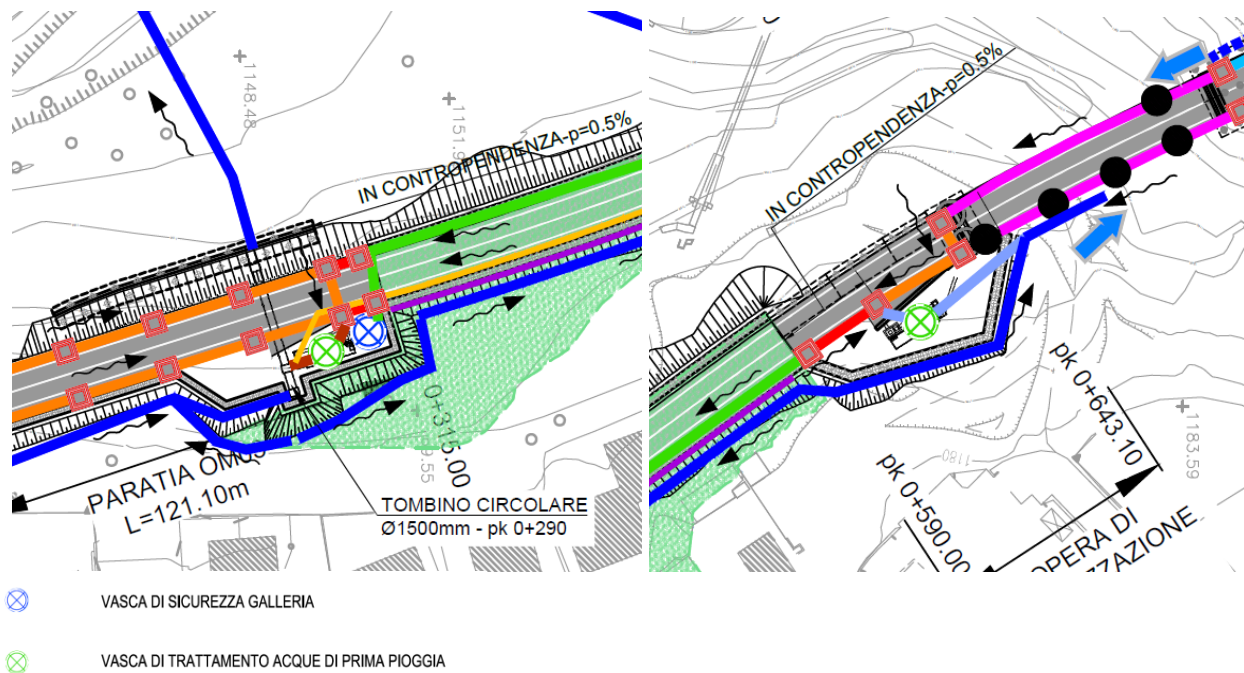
Planimetria idraulica - T01ID01DRRE02B
